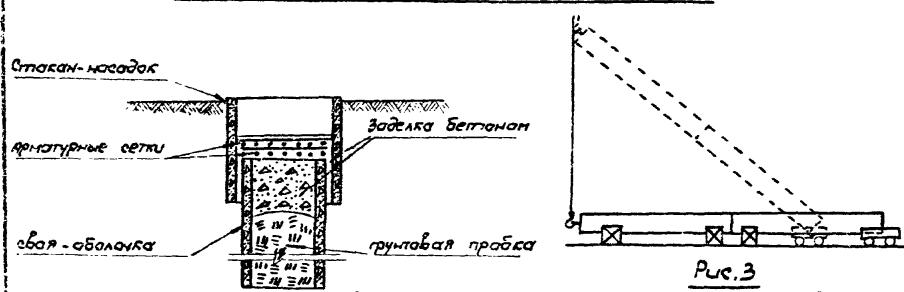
Конструкция свайного фундамента. Схема подъема свай-оболочки. Схема строповки свай-оболочек.
